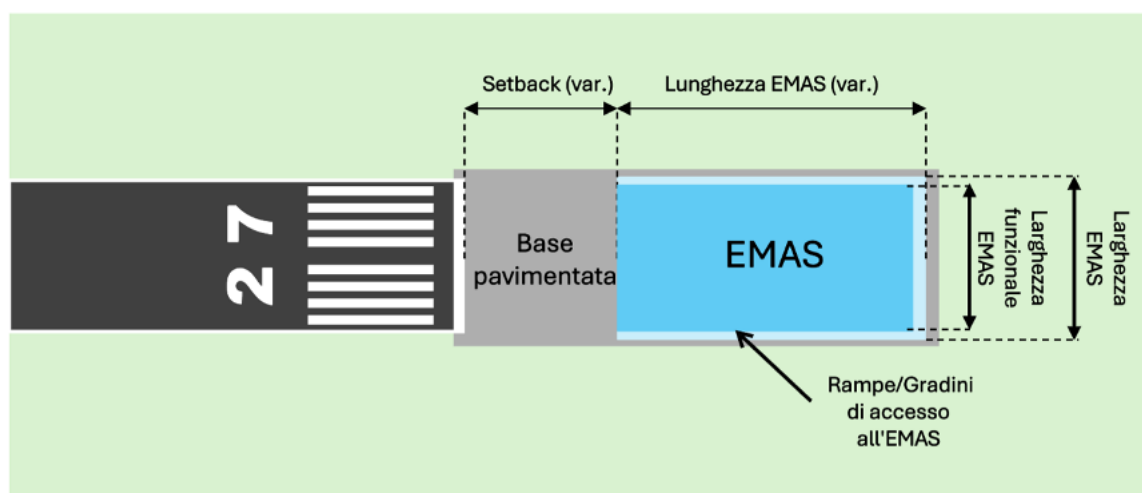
Planimetria generale di un sistema d'arresto EMAS
